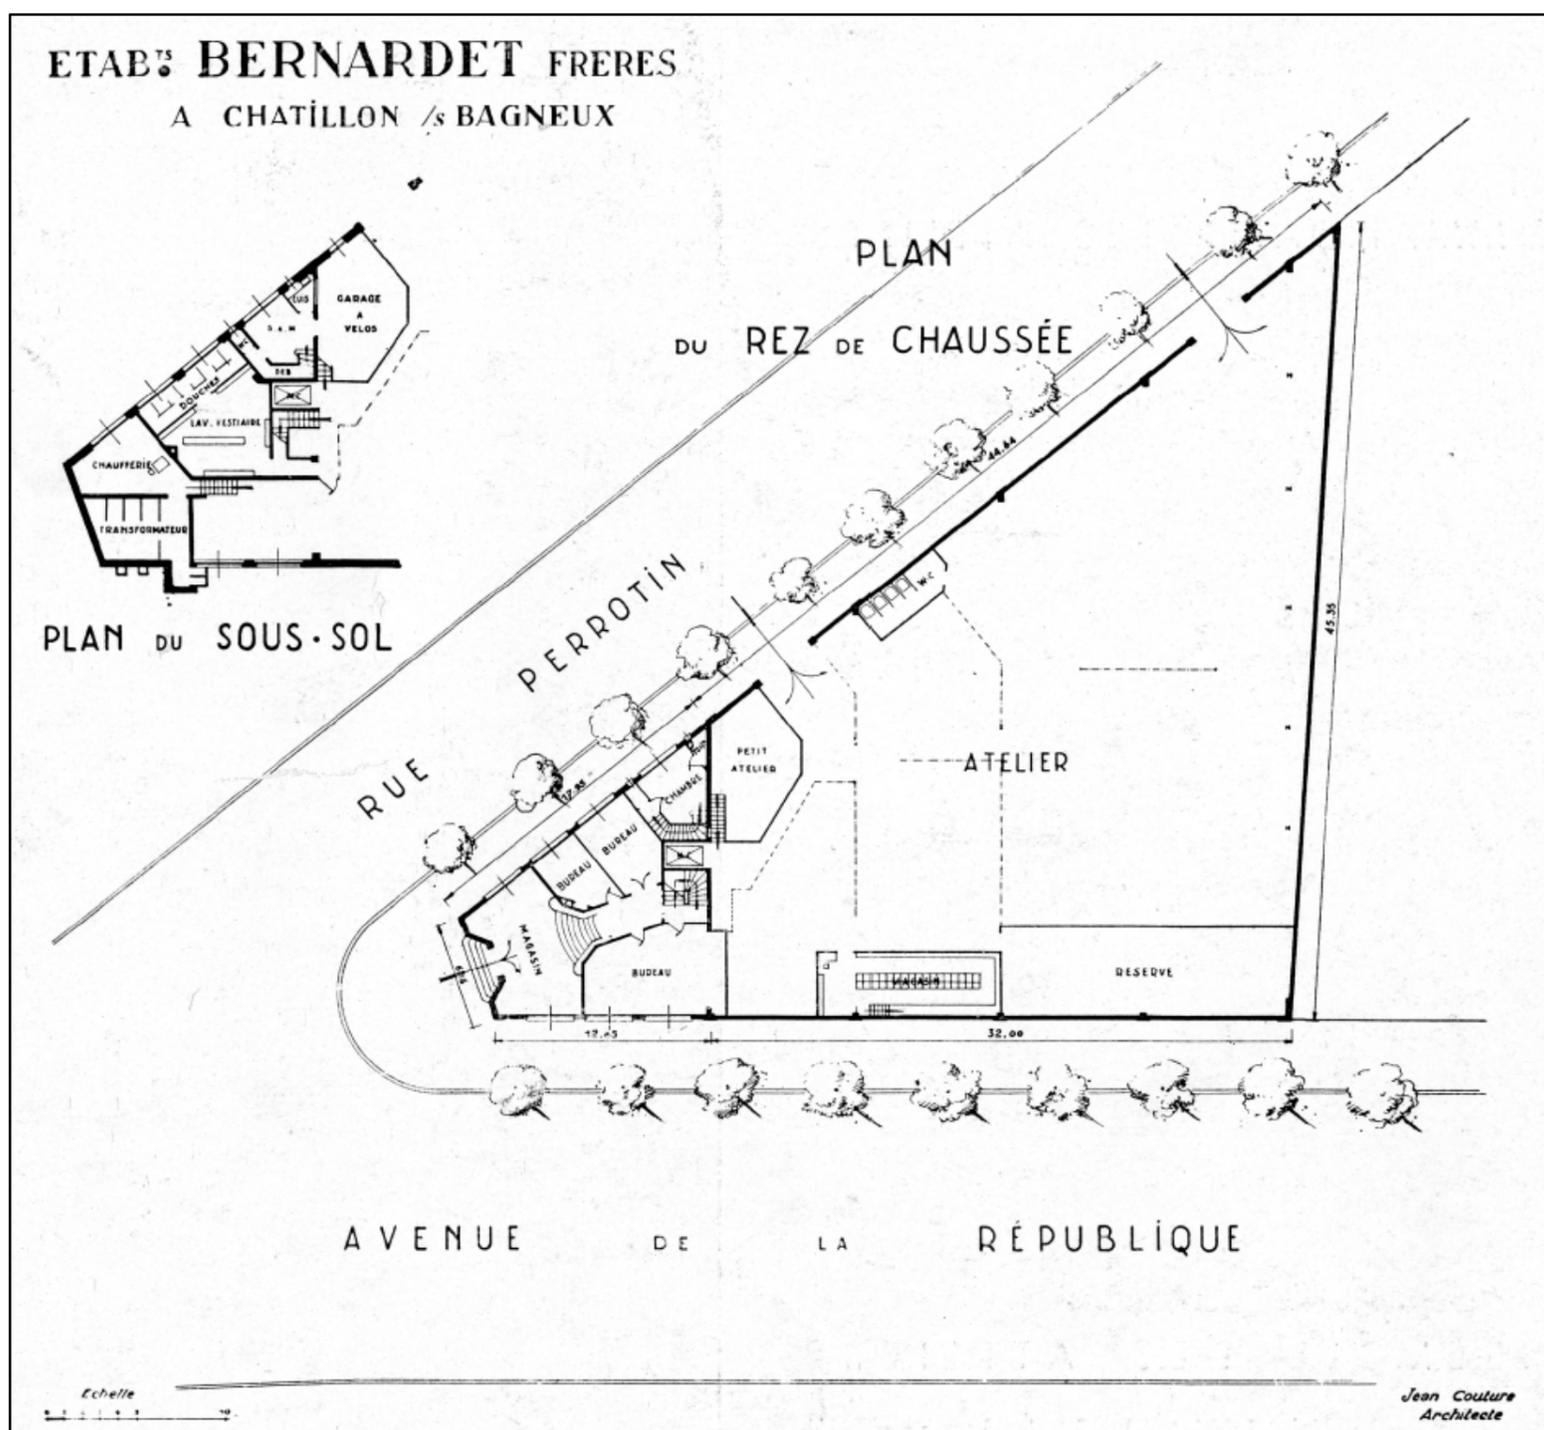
Plan de l'usine Bernardet (1936-1959)
